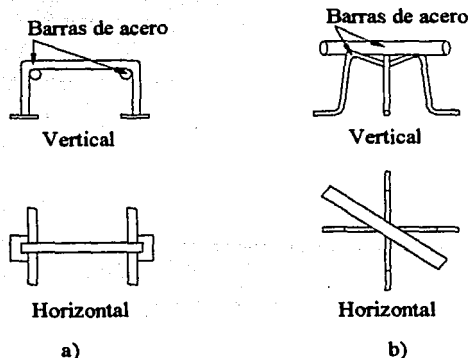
En el inciso a) y b) se muestran dos tipos de soporte para cables de presfuerzo en losas planas.
